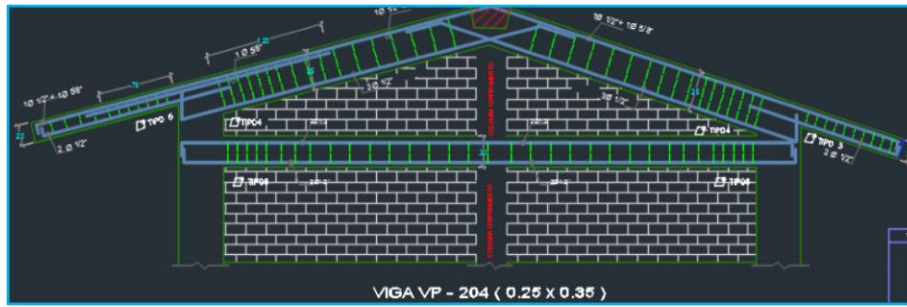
Detalle de las dimensiones de la viga VP-204 y el acero de refuerzo
